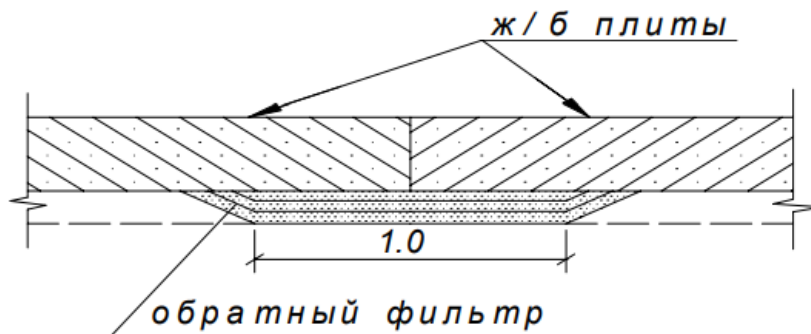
Элемент крепления откоса железобетонными плитами
